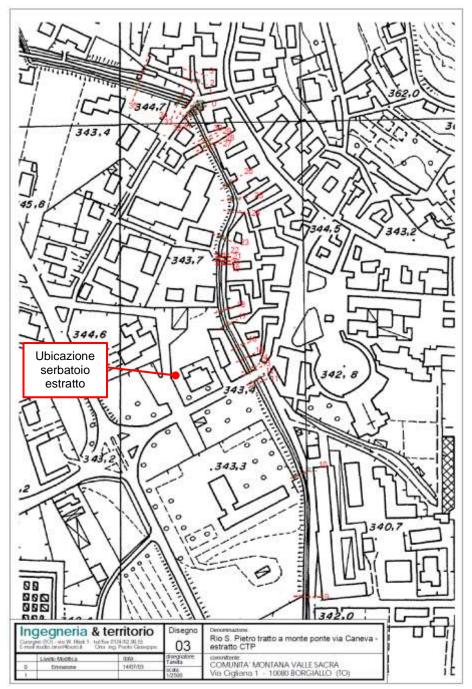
estratto CTP Castellamonte con indicazione delle sezioni del Rio San Pietro e del serbatoio interrato rimosso.
